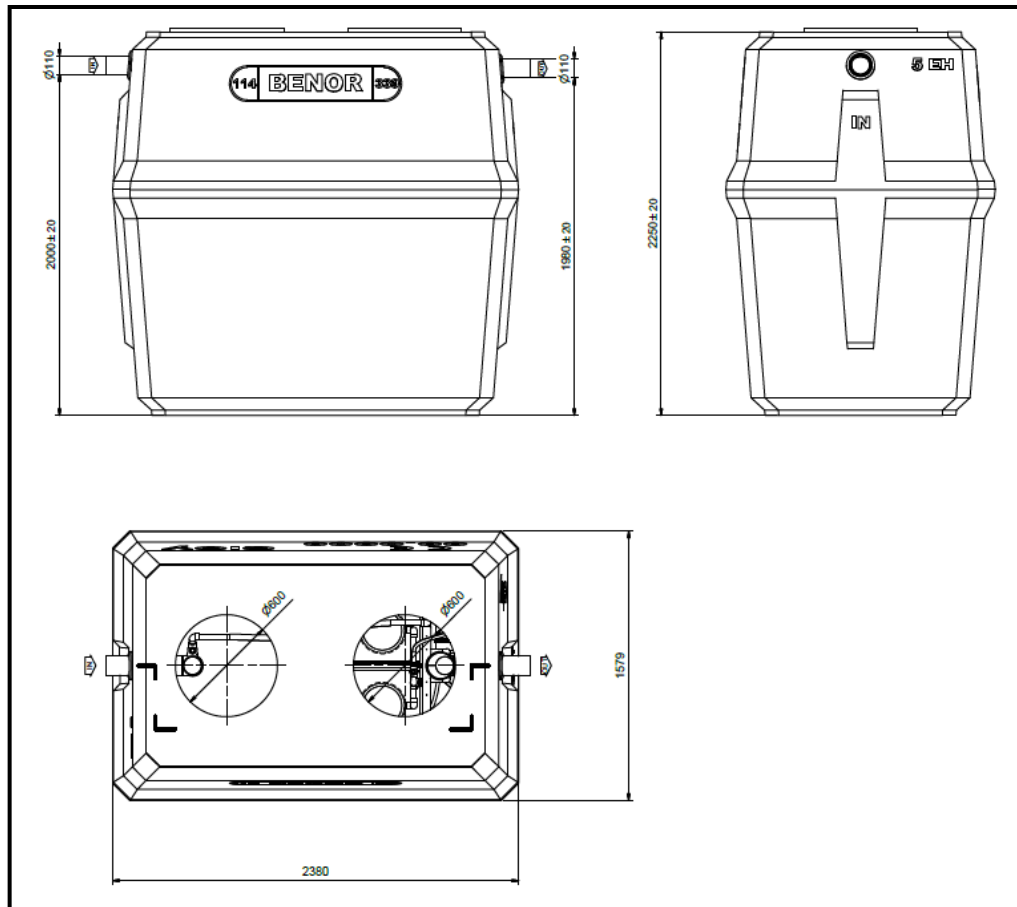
Plan d'encombrement des Oxyfix® C-90 5 et 6 EH (1)
